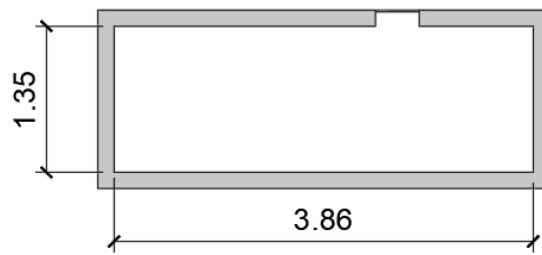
Planta baixa e vistas do Reservatório 1
